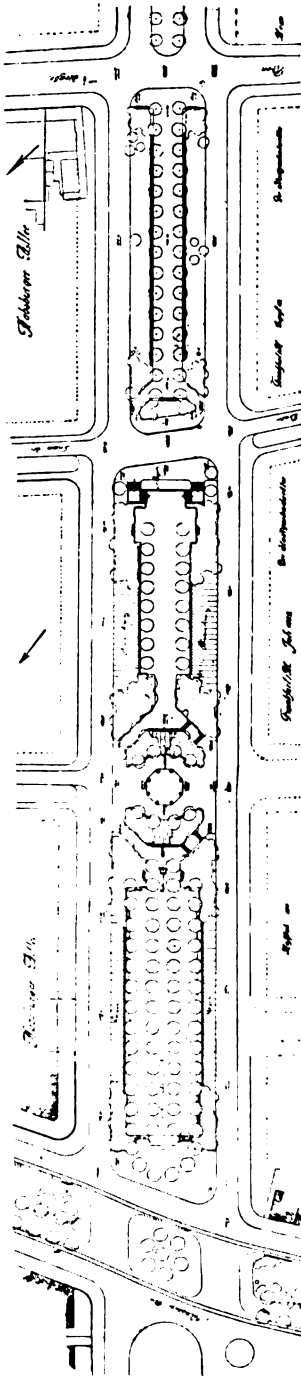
Aus: Koch, „Gartenkunst im Städtebau“. Grünstraße mit wachsendem Querschnitt. Frankfurt a. M.
